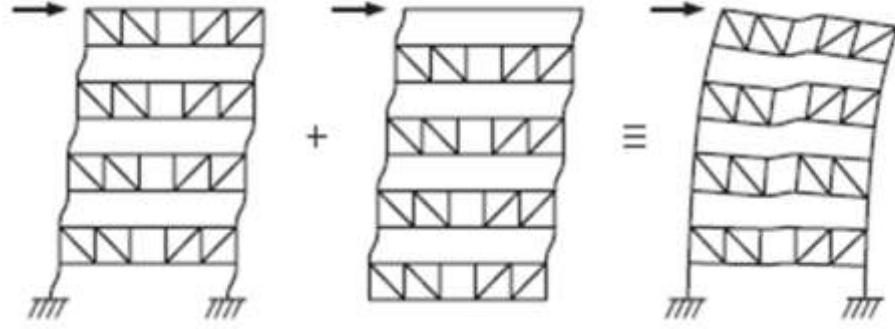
52: Tepe Makaslı Plan, Tepe Makaslı Plana Sahip Yapı Davranışı (İlgin,2006)
